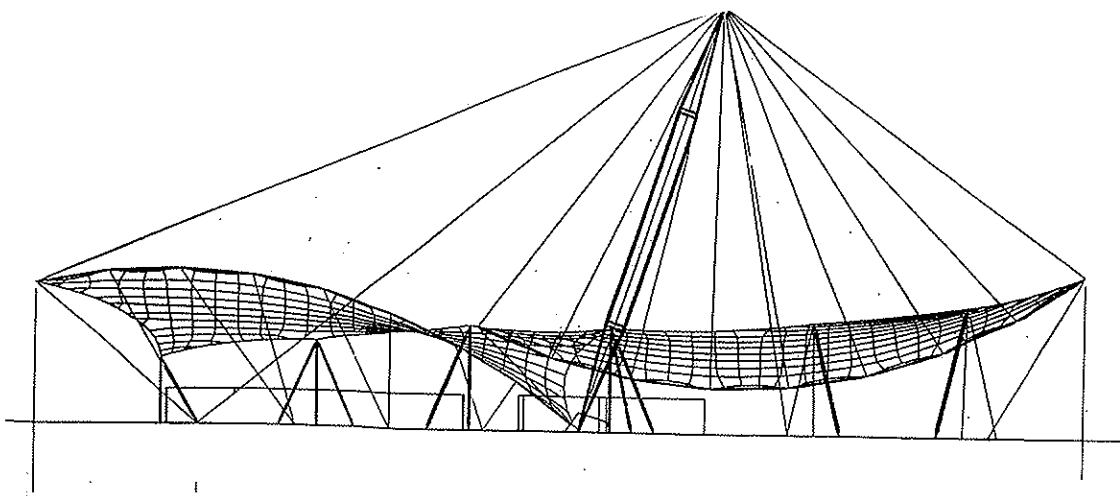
Alzado lateral de la Puerta de la Barqueta.
